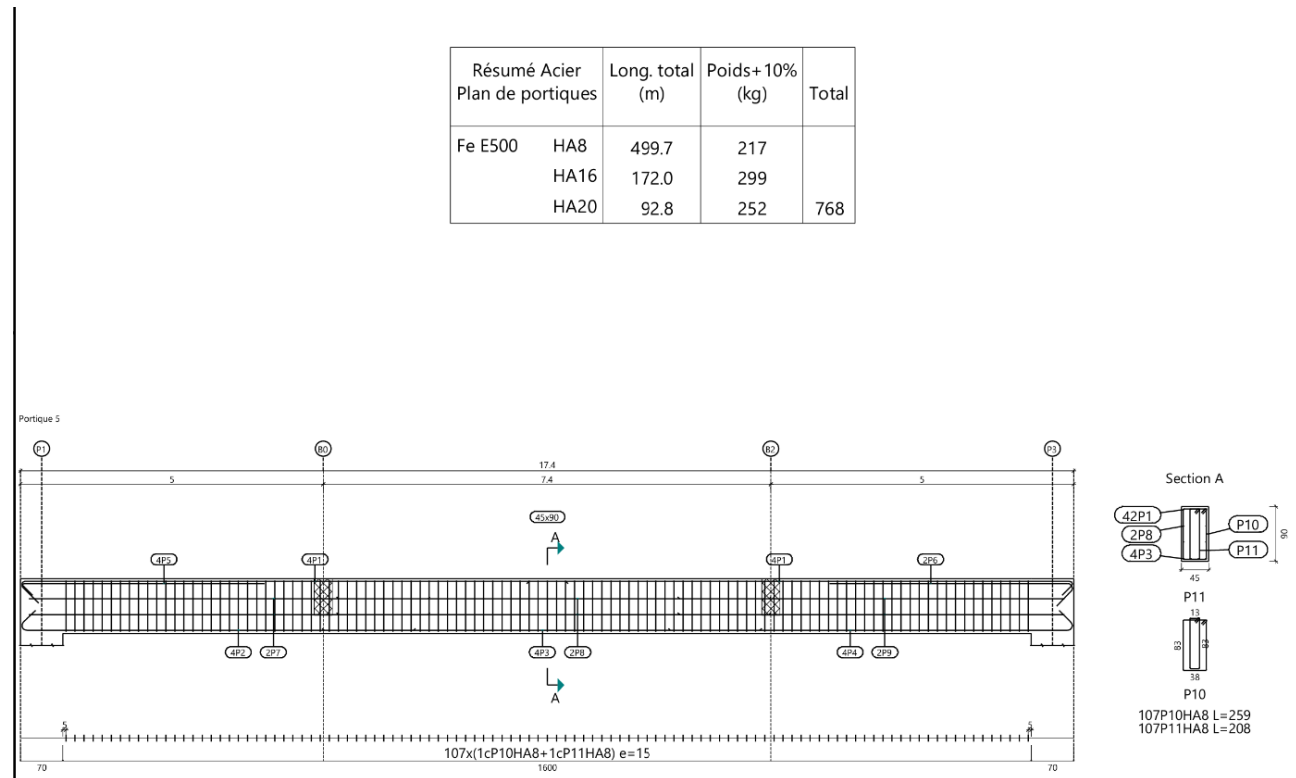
Plan de ferrailage poutre principale -variante 2
